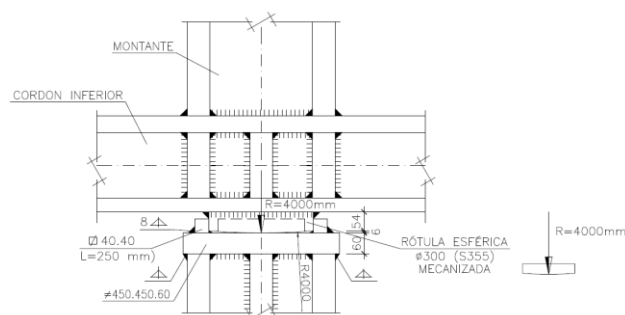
Apoyo oscilante esférico (R=4000 mm) sobre soporte mixto
